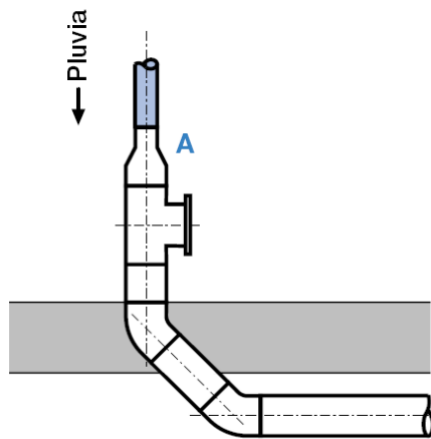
Aumento do diâmetro antes da laje de pavimento, [12]
